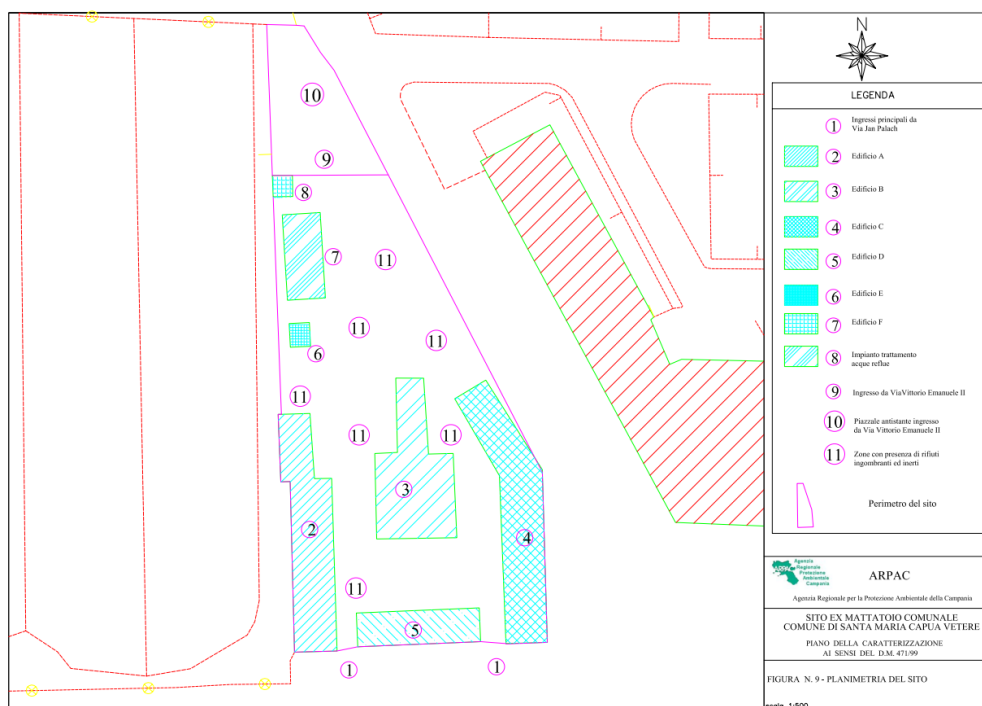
Planimetria del sito e individuazione degli edifici esistenti [fonte: Piano di Caratterizzazione ambientale redatto da ARPAC nel febbraio 2006]
